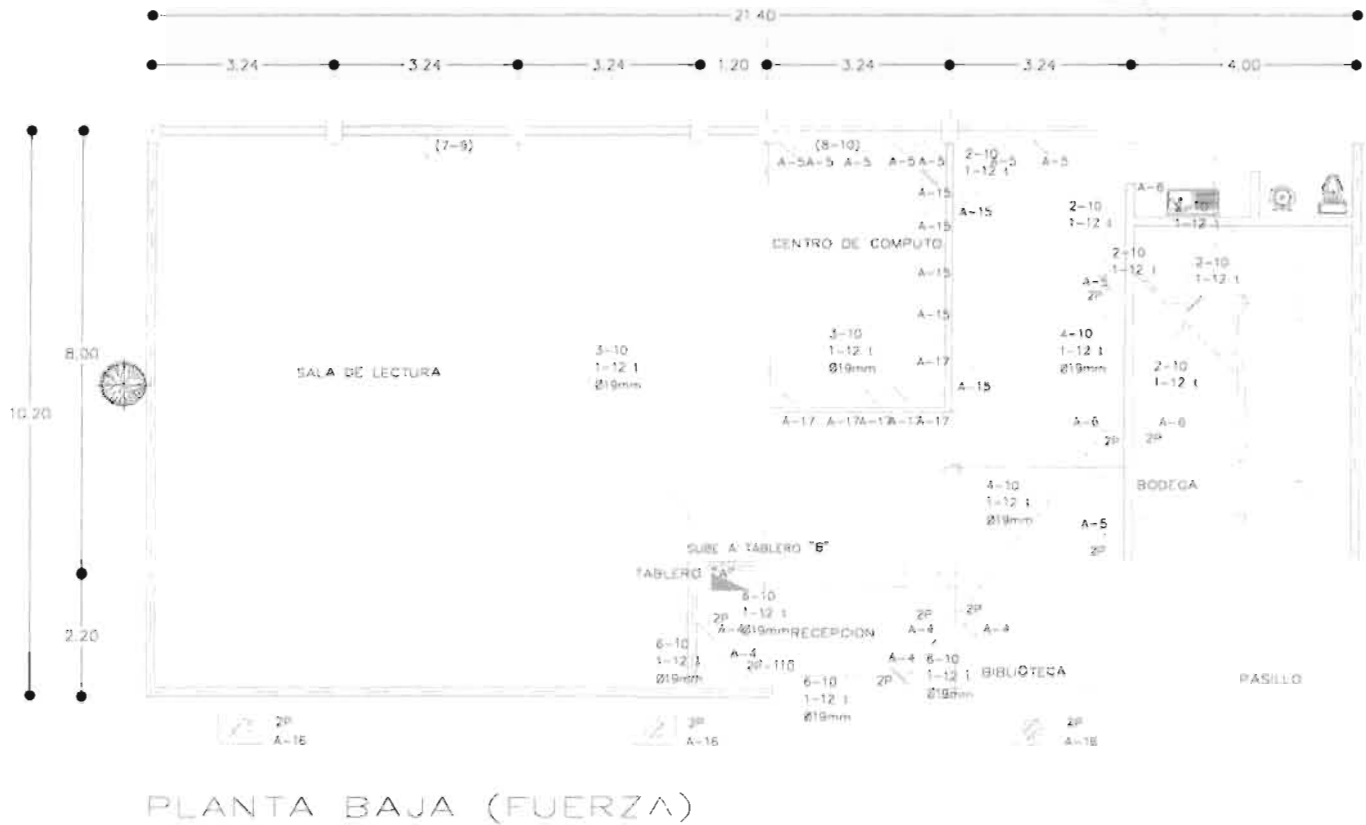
Plano de Cargas de la Planta Baja del Edificio B.
